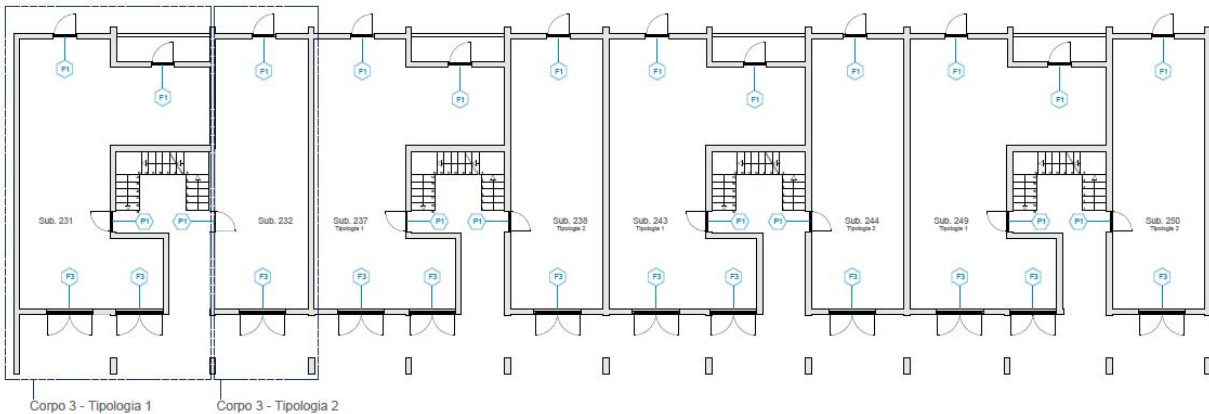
Pianta stato di fatto, piano terra – Corpo 3
